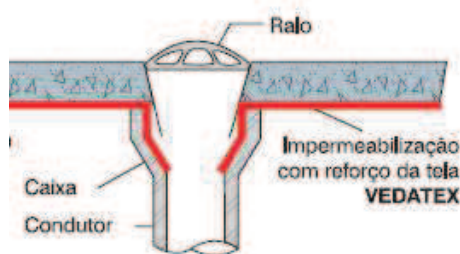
Detalhe da impermeabilização e grelha dos ralos
